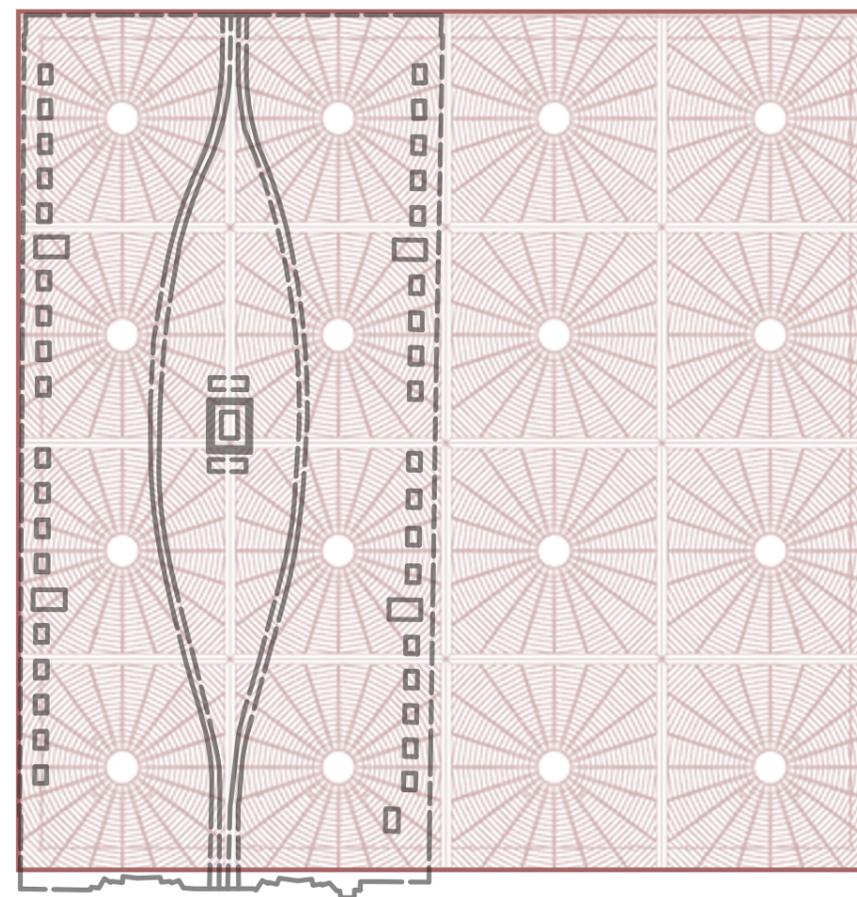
Sovrapposizione pianta Palazzo del Lavoro a confronto con l'ortofoto di Piazza San Carlo, elaborazione degli autori.
